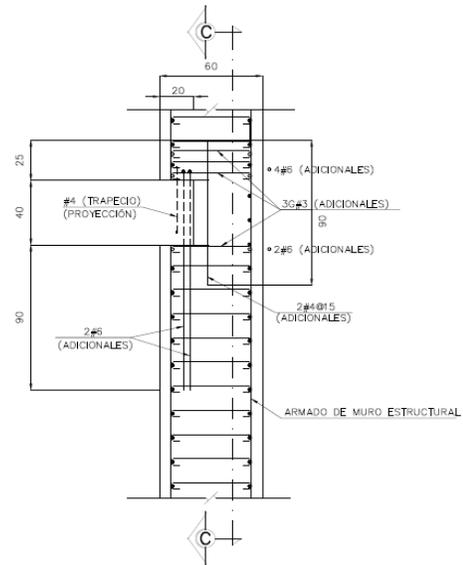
Detalle 6 para espacios de apoyo para vigas cerrojo en colados subsiguientes.
